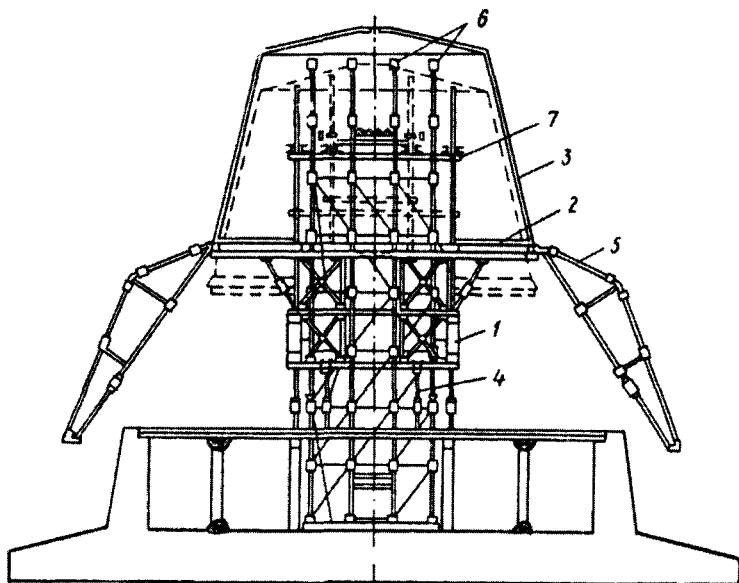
Монтажное положение после третьего подъема опорно-переставной рамы: 1 – каркас головки; 2 – монтажная площадка; 3 – каркас шатра; 4 – внутренняя подвеска; 5 – наружная подвеска; 6 – стойки шахтного подъемника; 7 – опорная переставная рама
